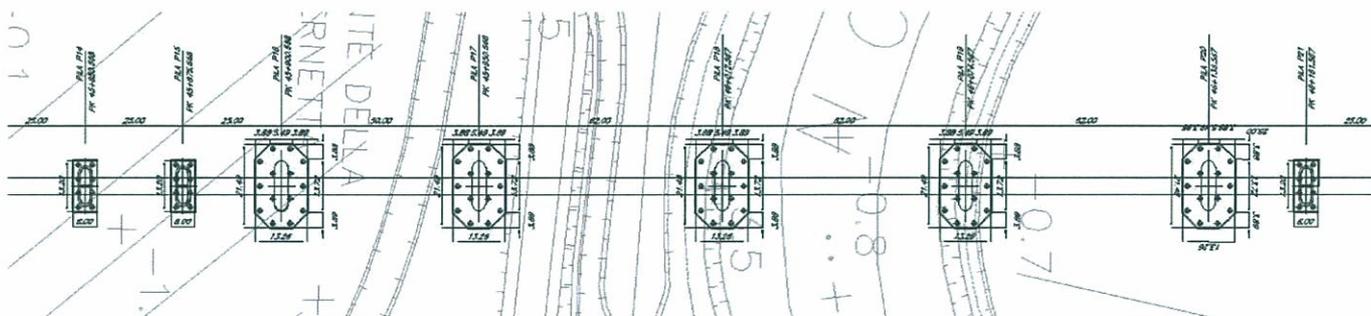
Pianta dell'attraversamento del fiume Fosson e del canale Cerretta.
